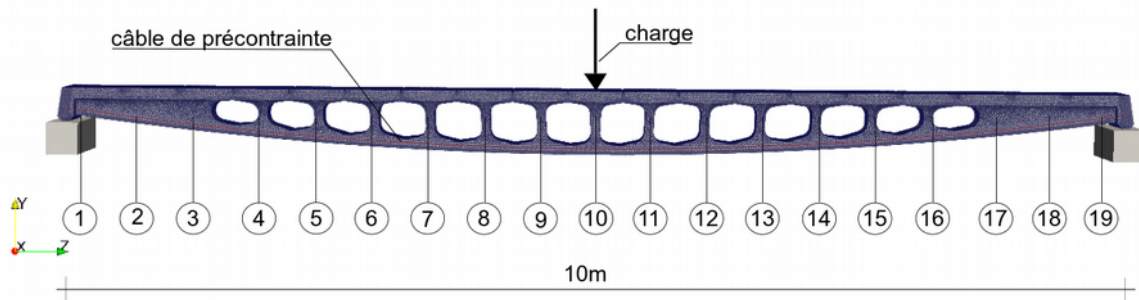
Poutre en pierre massive précontrainte – nomenclature.
